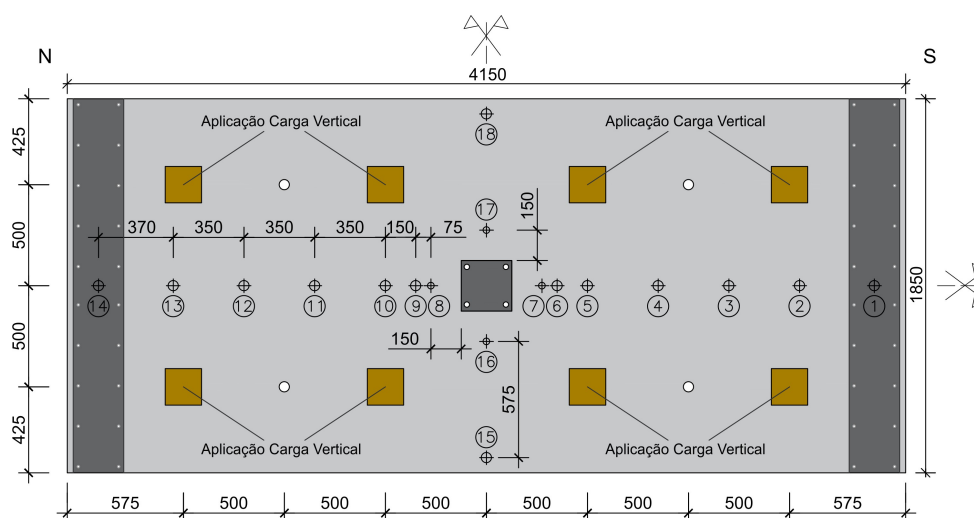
Planta com a localização dos defletores e dos pontos de aplicação das cargas verticais na laje (desenhos sem escala e dimensões em mm).
